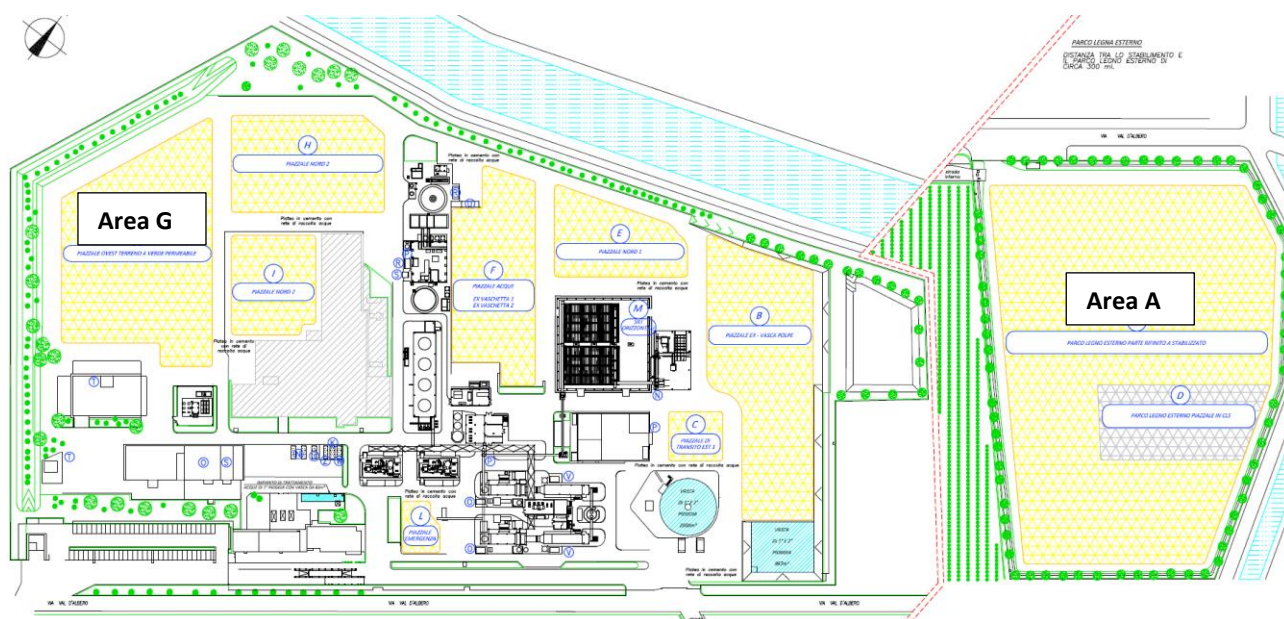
Stralcio della planimetria depositi e stoccaggi della Centrale
